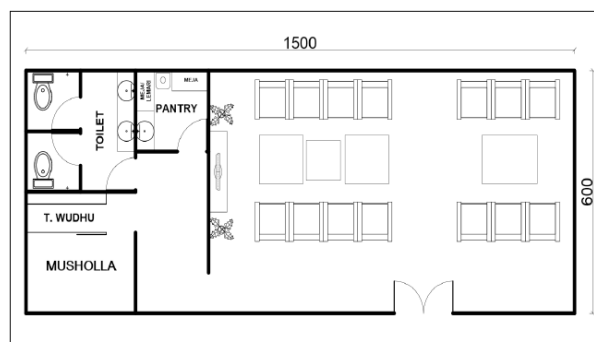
23 Tipikal Denah Ruang UPT Kru KA
